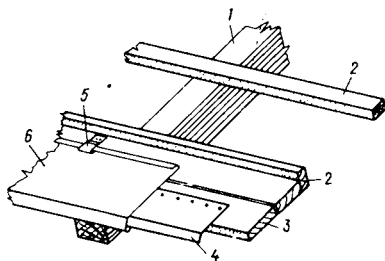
Обшивка разжелобка крыши с битумной кровлей
